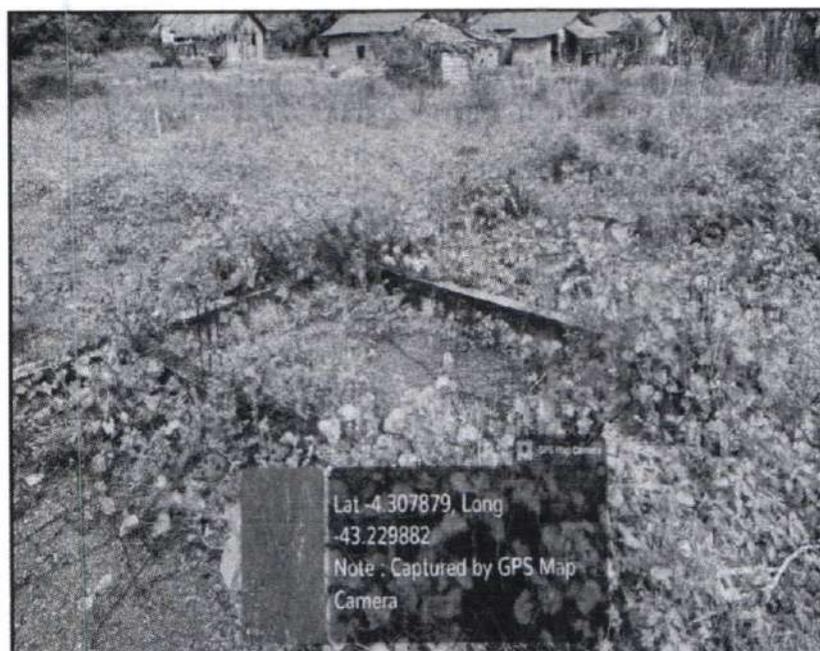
Vigas baldrame encontram-se expostas, sem o aterro previsto executado e sem o recebimento de impermeabilização. Fonte: elaboração própria
